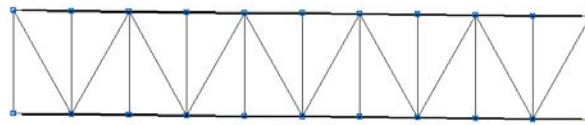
Vista de un plano 2D en planta creado para facilitar el proceso constructivo
